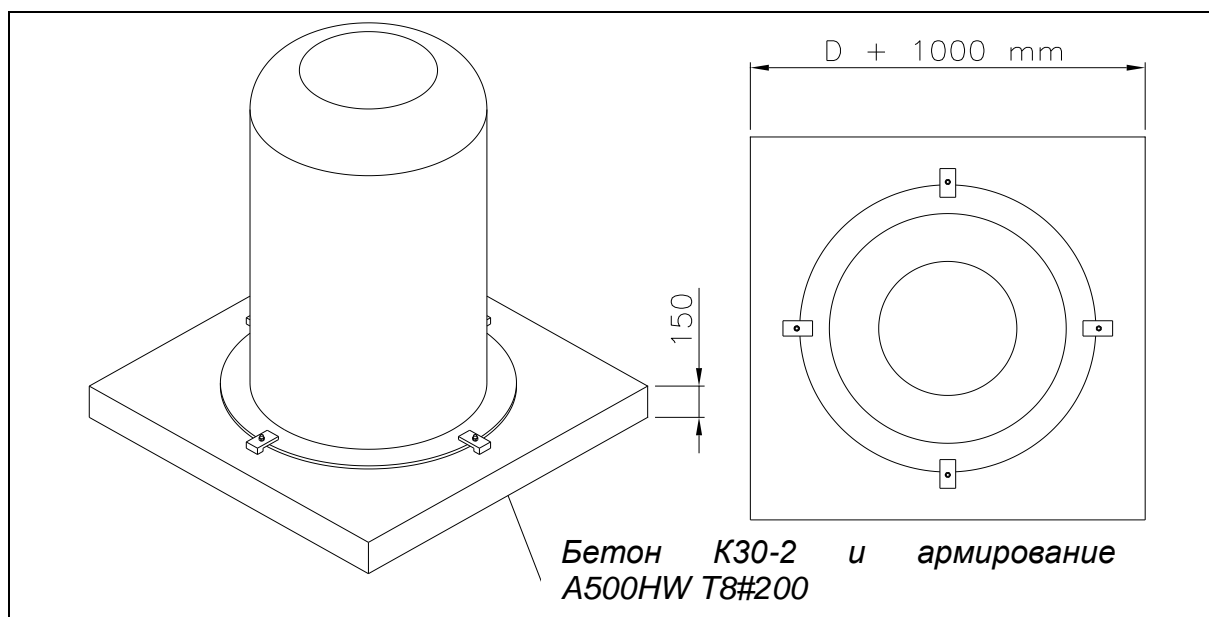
Принципиальный чертеж заанкерванного резервуара.
